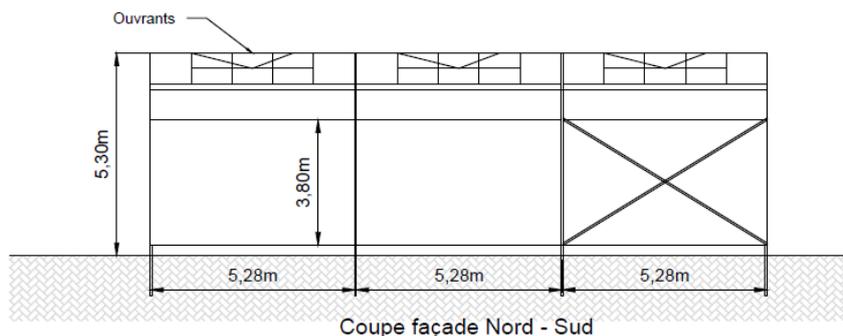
Coupe type serre multi-chapelles, côté pignon - Source : Reden Solar
